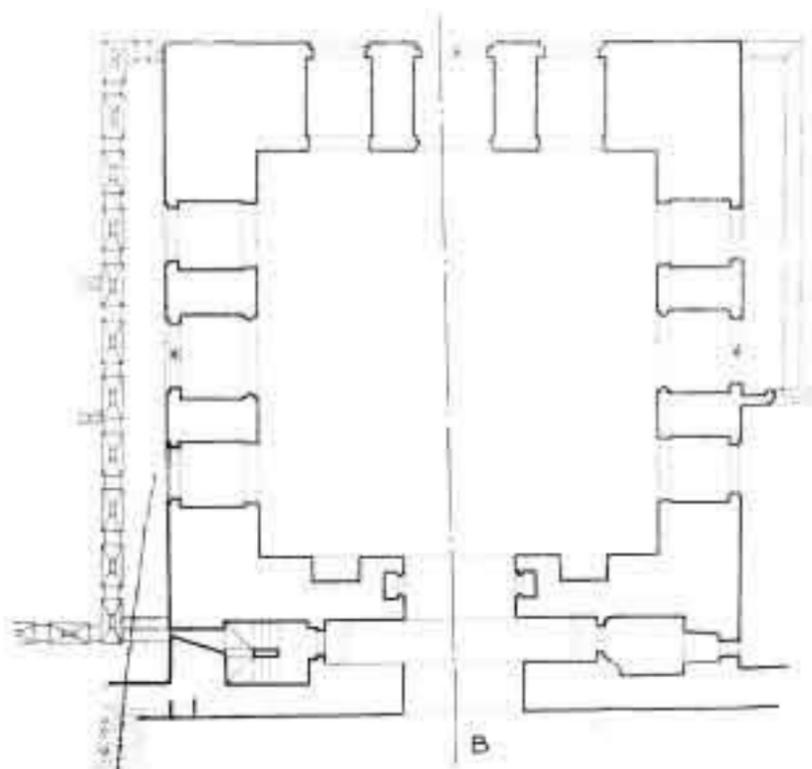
Plano de la 2.ª planta, correspondiente al Salón de Embajadores, en su estado actual
